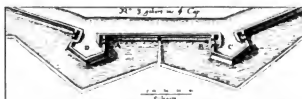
Polygonaler bastionierter Grundriss nach Lorini.
